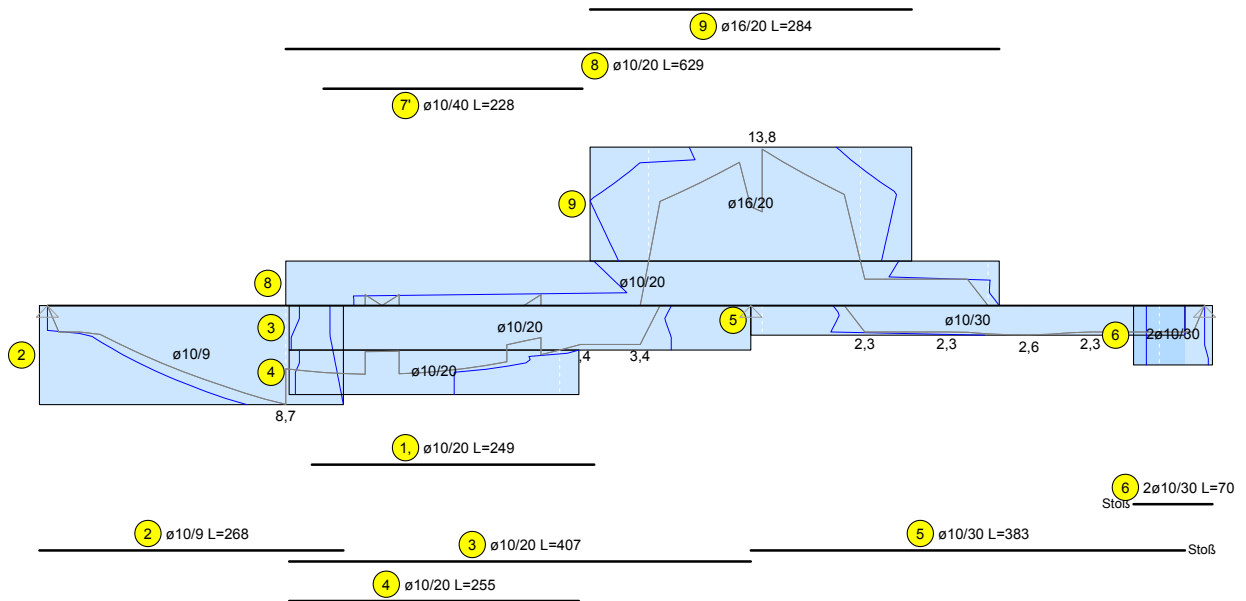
Konstruierte Längsbewehrung. Maßstab 1 : 66,7, 1cm = 6,67cm².
